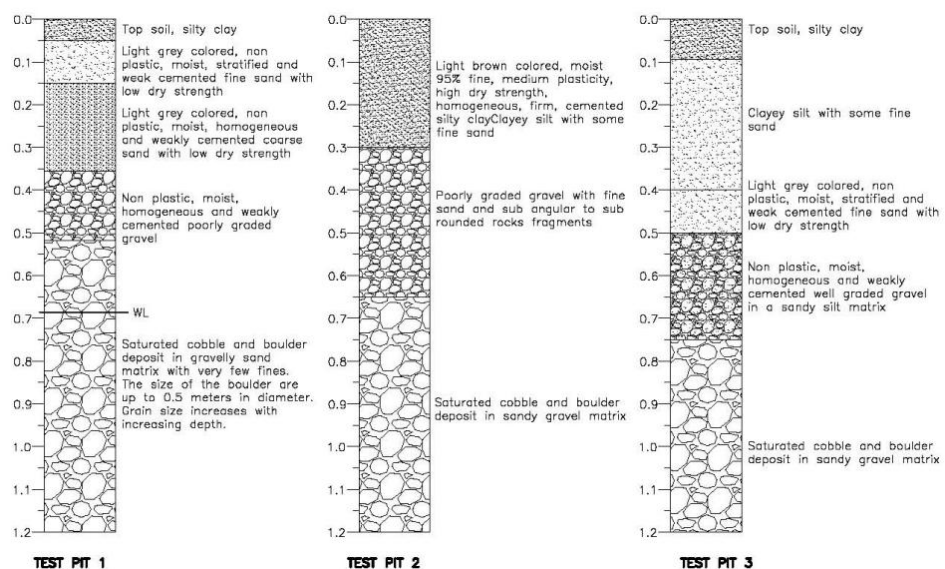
河床材料調査結果（取水地点左岸 test pit 1, 右岸 test pit 2, および上流左岸 test pit 3）
